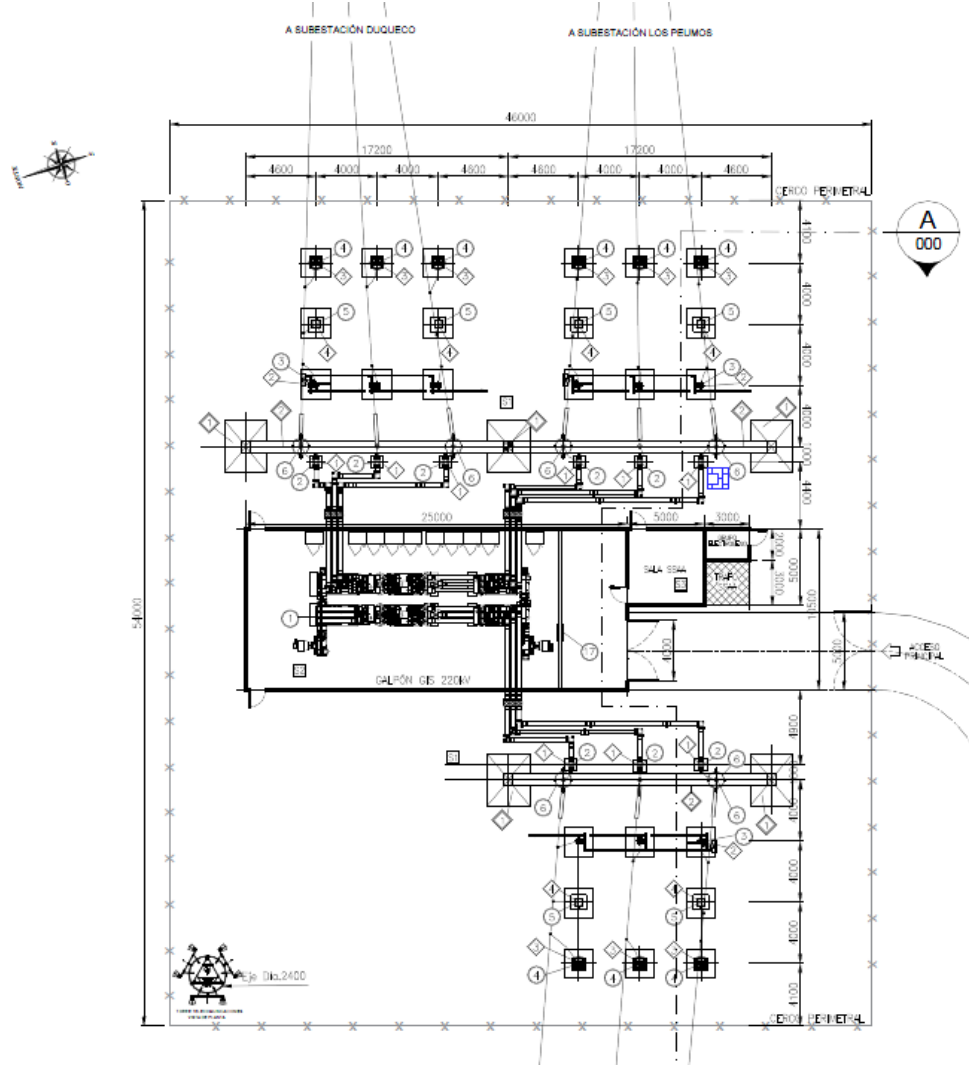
Diagrama de planta con disposición de equipos propuesto para la Nueva S/E Seccionadora La Invernada.
